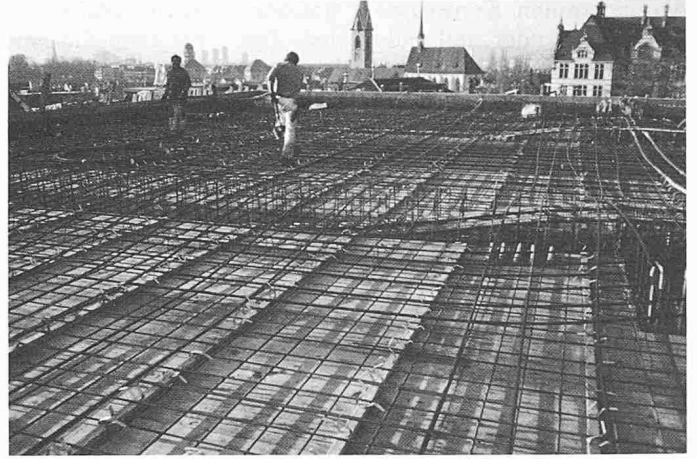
Dachgeschoss, Decke über Opernstudio, Konservatorium und Musikhochschule, Zürich
